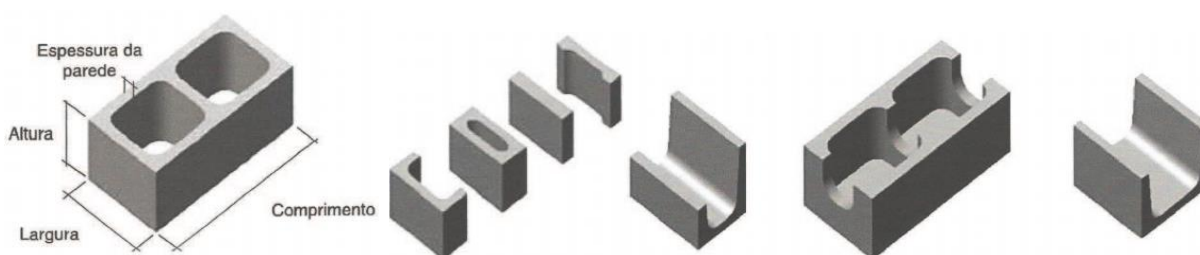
Blocos vazados de concreto simples, compensadores e tipo canaleta
